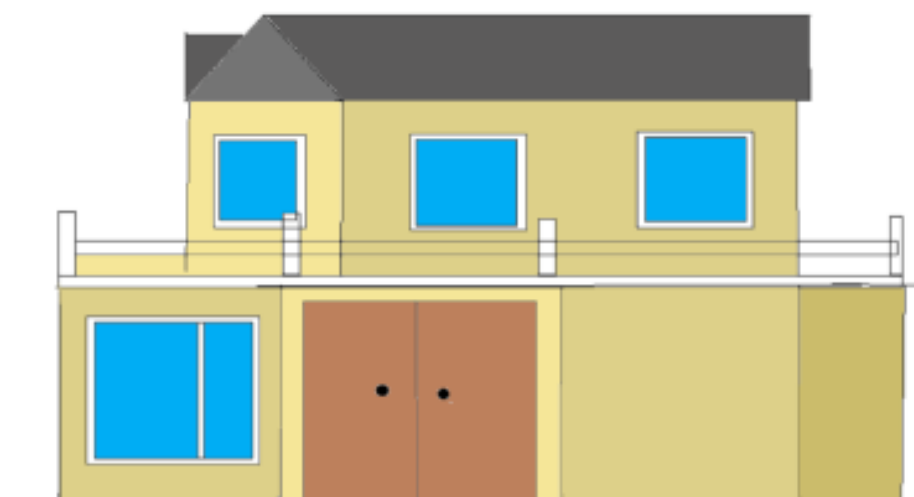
Решение фасадов жилого дома (западный фасад)
